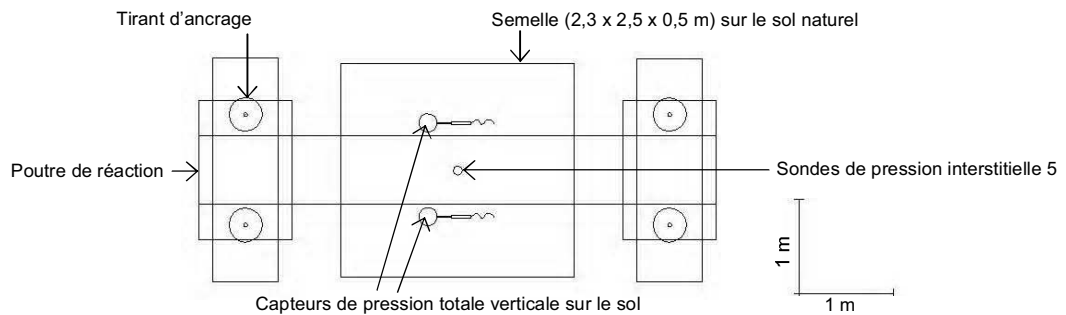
Vue en plan de la configuration de l'essai de chargement de la semelle (2,3 x 2,5 x 0,5 m) sur le sol naturel.
